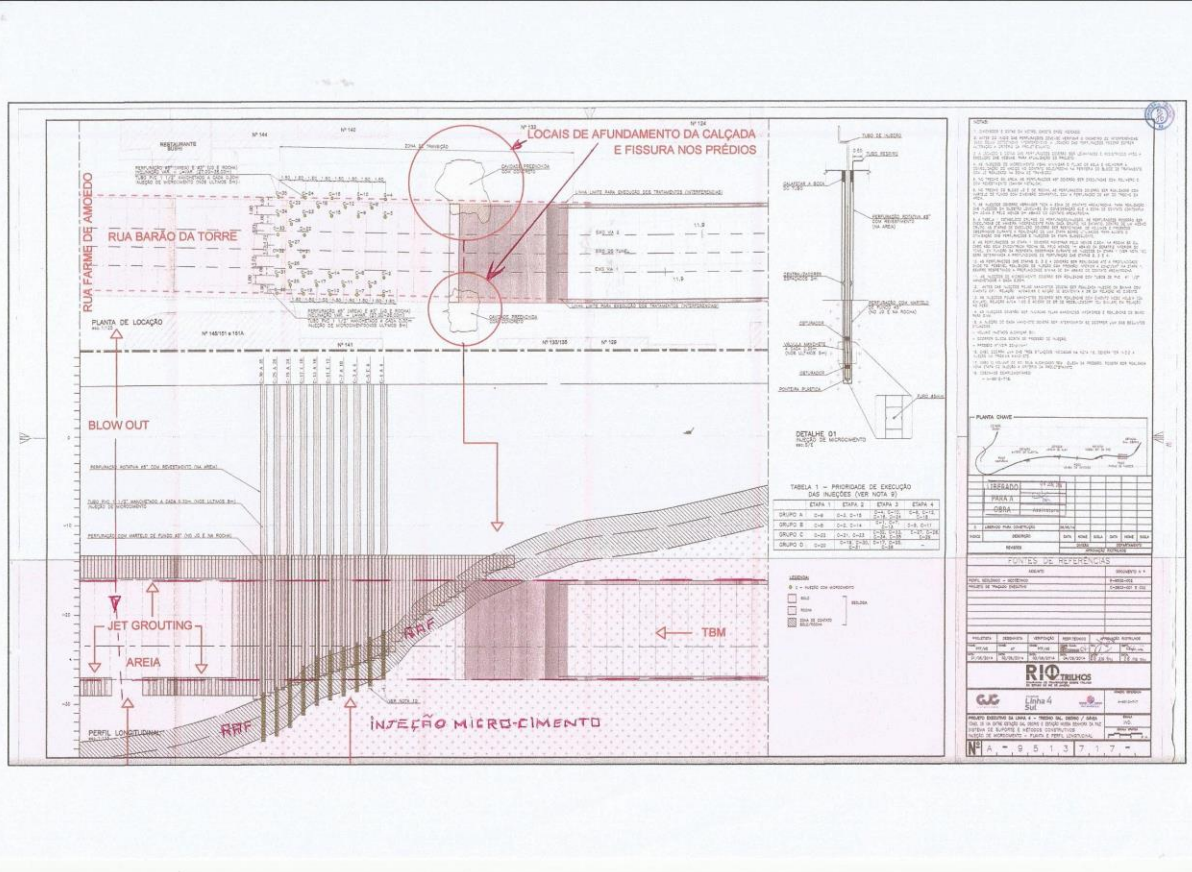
Planta e Perfil Longitudinal – Injeção de Microcimento – Projeto Executivo
